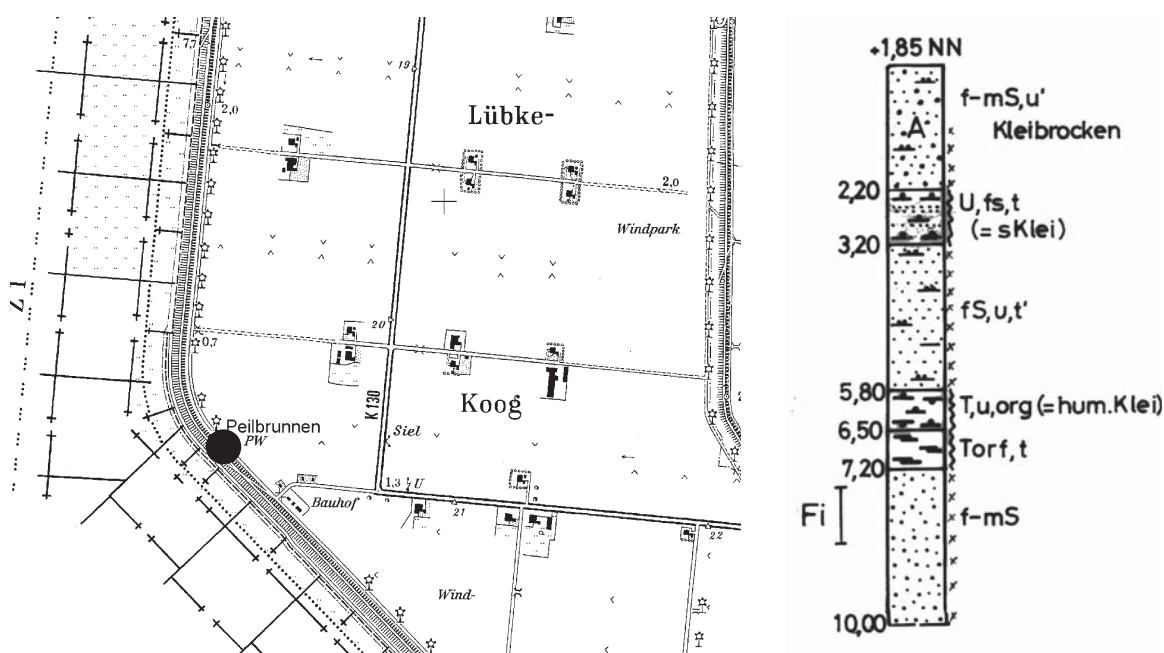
Lageplan mit Bohrprofil und Lage der Filterstrecke am Schöpfwerk F.W. Lübkekoog
